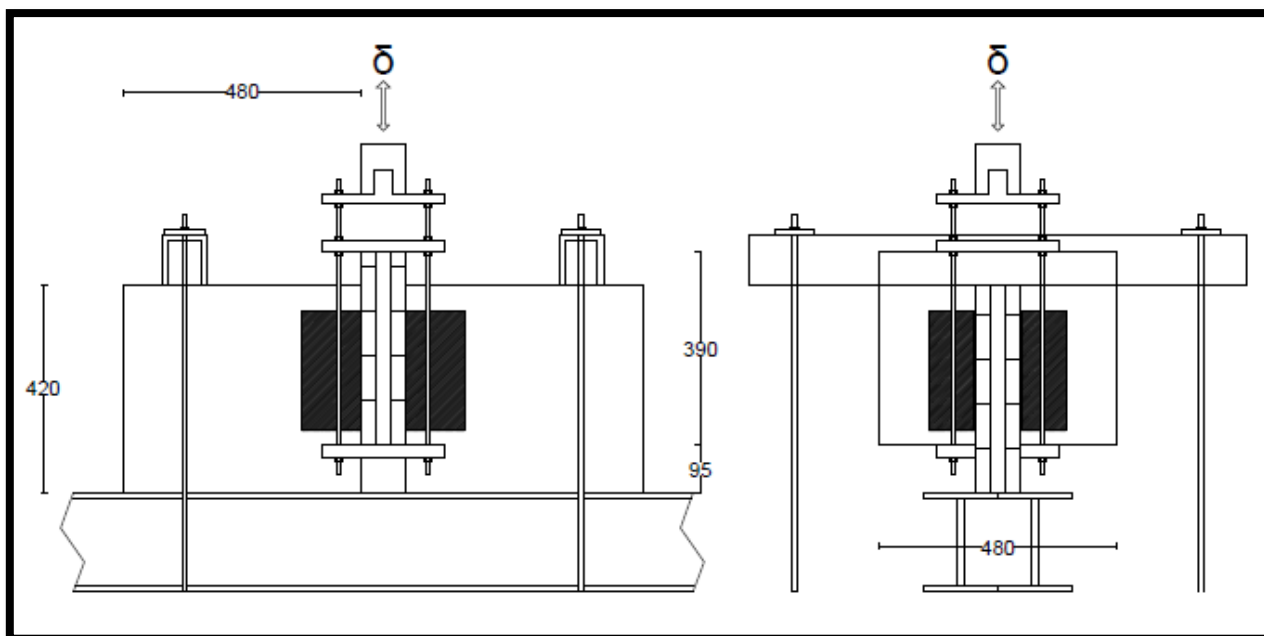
Configuración de prueba para conexión muro-losa del angle bracket cargado en corte.
